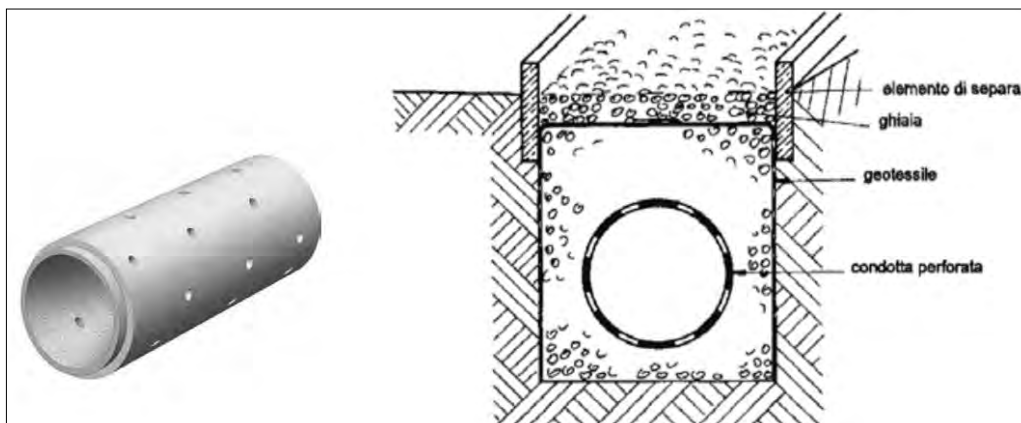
Schema illustrativo tubazione drenante (diametro 600 mm).
